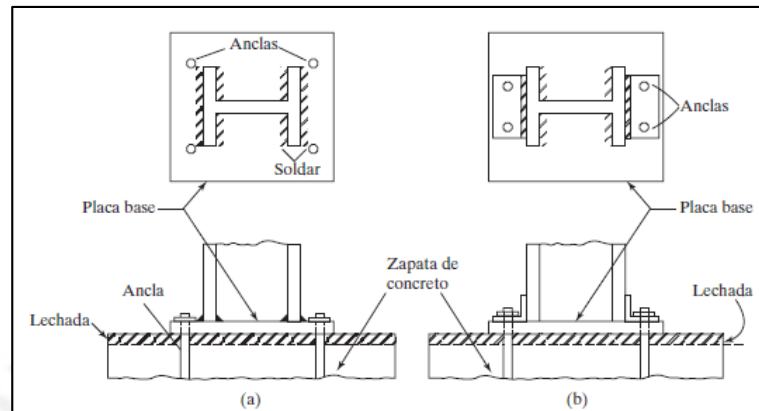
DETALLE DE PLANCHA BASE Y PERNOS DE ANCLAJE (FUENTE: ESTRUCTURAS DE ACERO MCCORMAC 2010)
